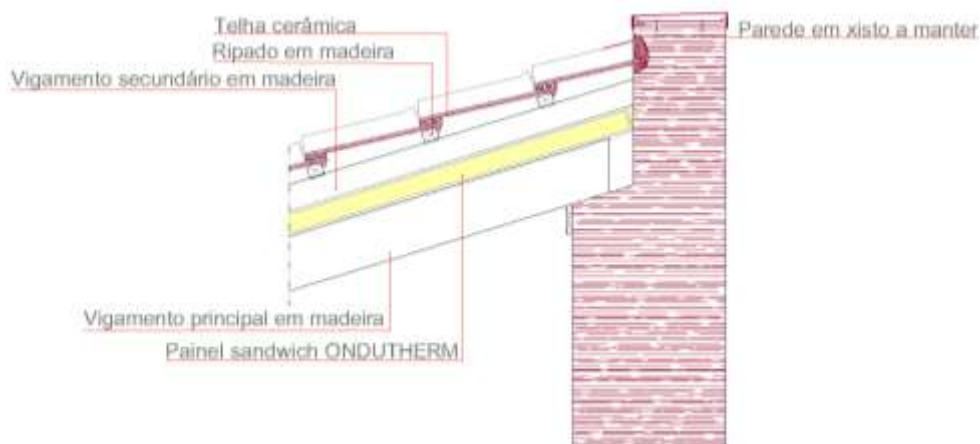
Pormenor construtivo da cobertura inclinada revestida a telha cerâmica com painel *sandwich* (P4)
